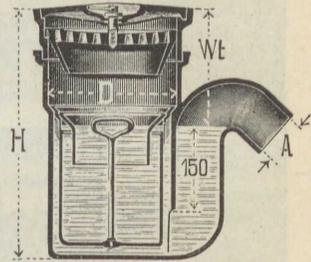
Fußbodeneinlauf mit Hochwasserverschluß.
